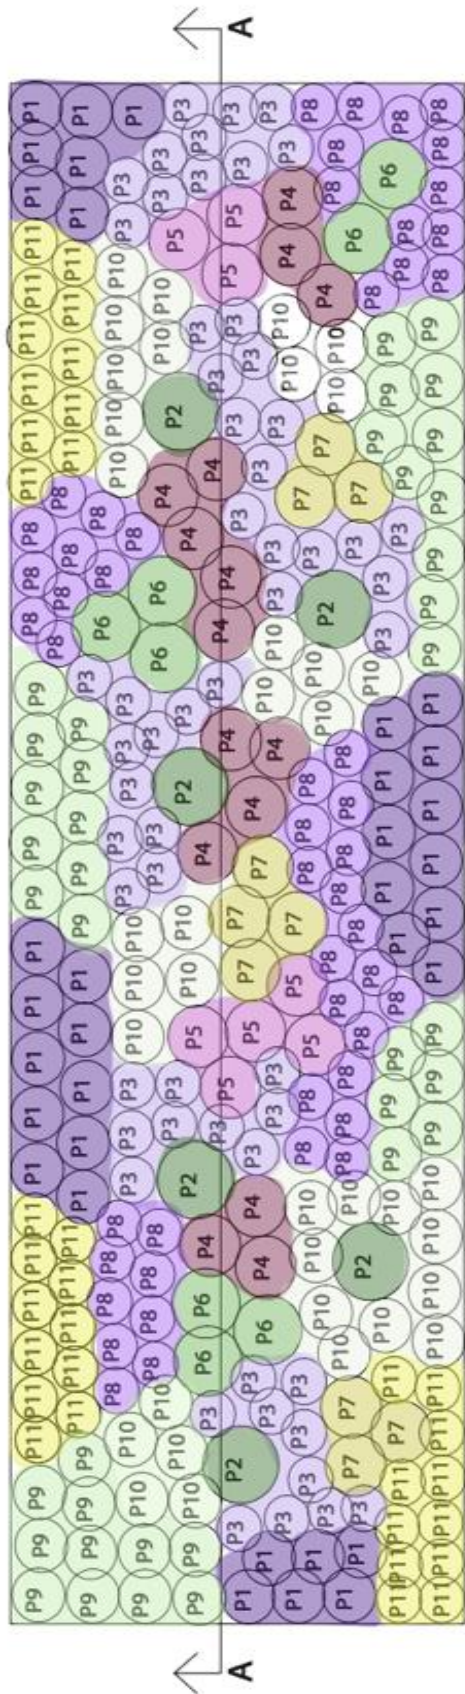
Planteringsplan för en extrem torr och skuggig plantering. Ej skalenlig.
